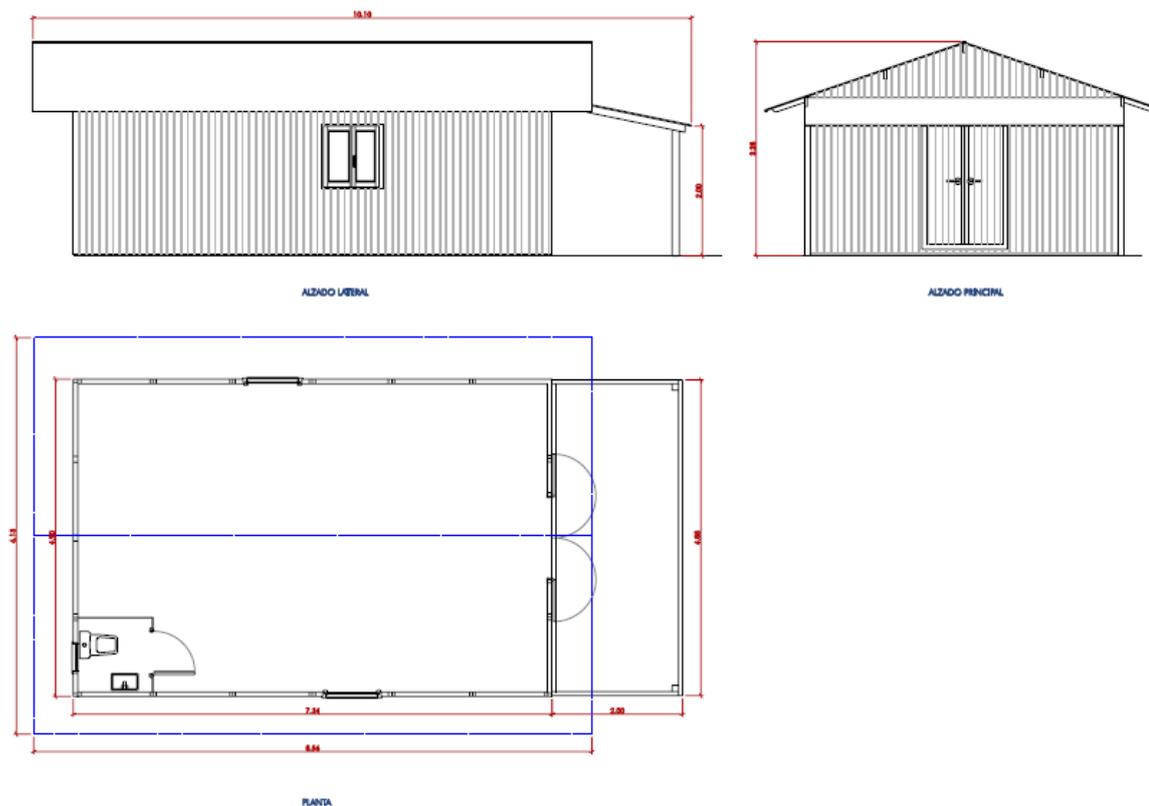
Ejemplo de planta y alzado de un módulo tipo de caseta prefabricada para miniclub de actividades náuticas.
